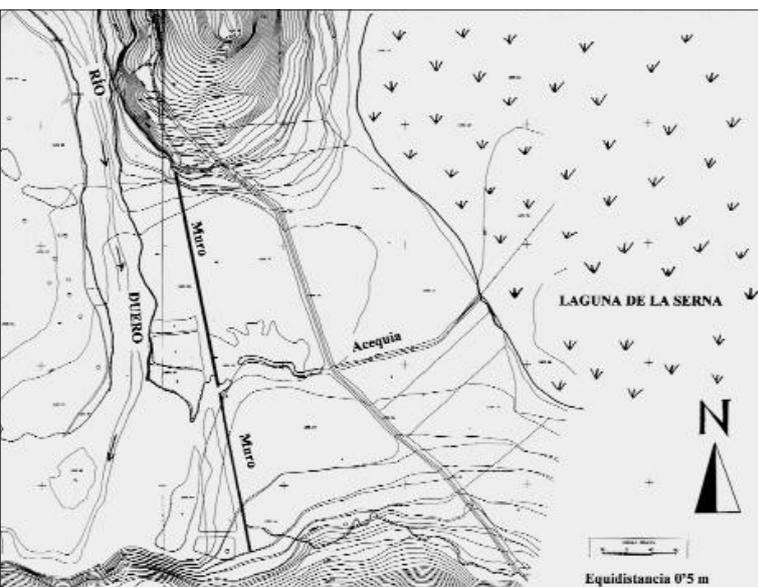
Planta y sección del Muro de la Serna, en Hinojosa de la Sierra.
